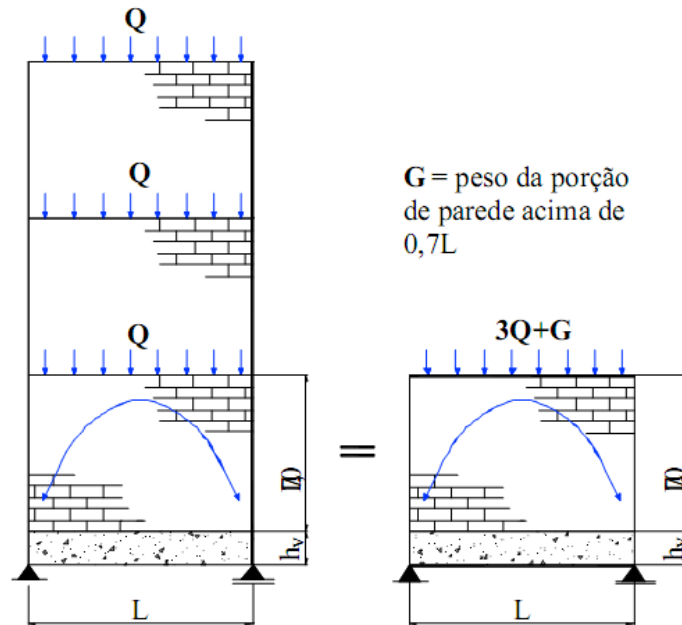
Sistema parede-viga com carregamento equivalente. (PAES, 2008)
